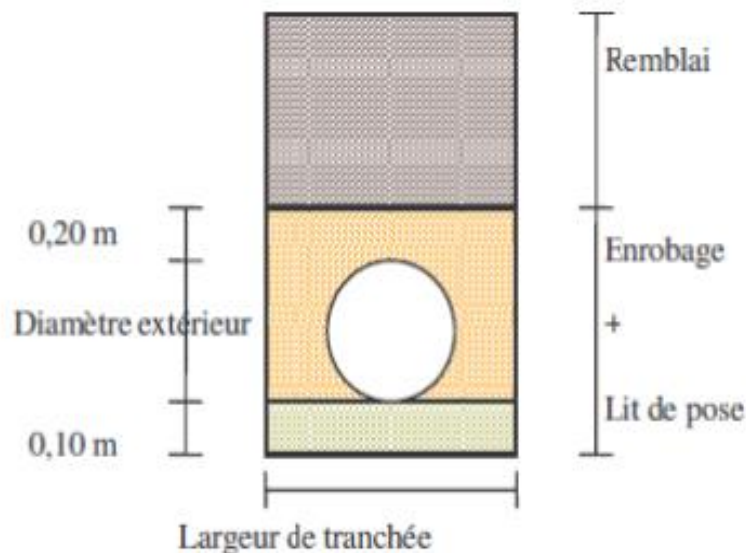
coupe de pose des conduites d'AEP dans la tranchée
